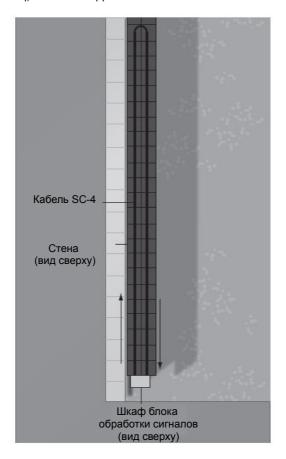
Замкнутая петля под крышкой (вид сверху)
